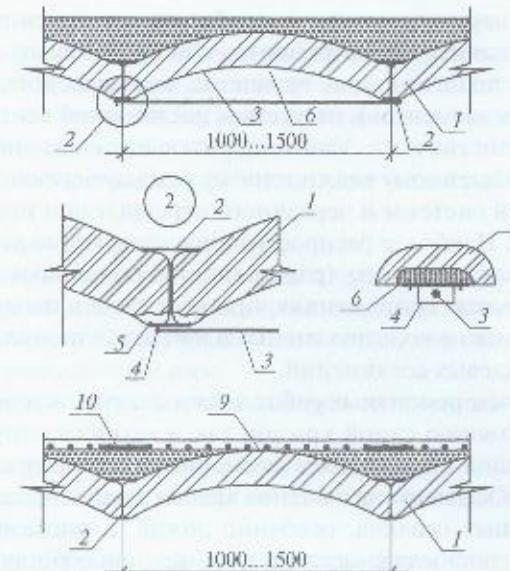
Усиление каменных перекрытий установкой затяжек для восприятия распора:
